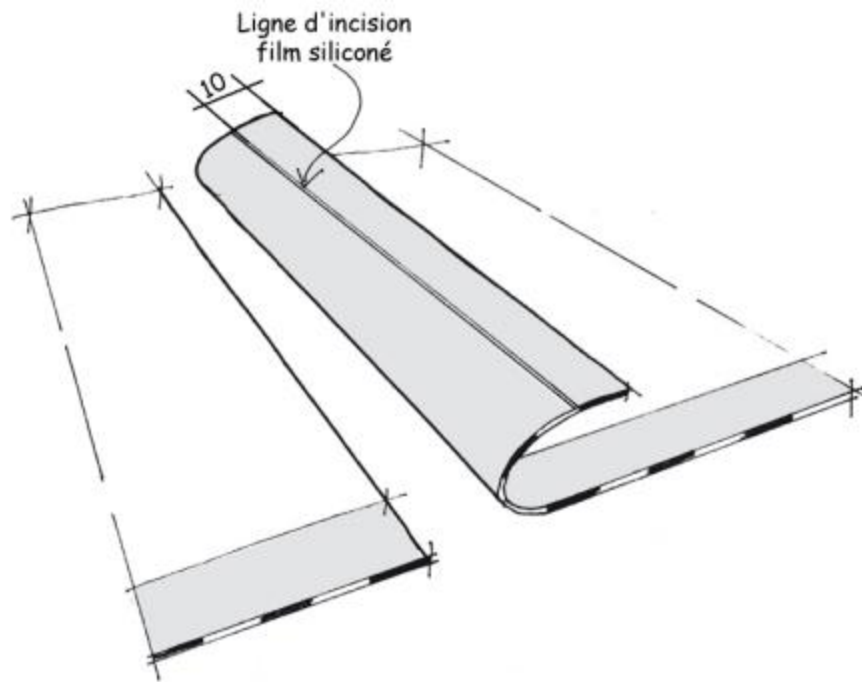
Recouvrement des lés du joint transversal de la feuille EUROHELASTO ADH SI
